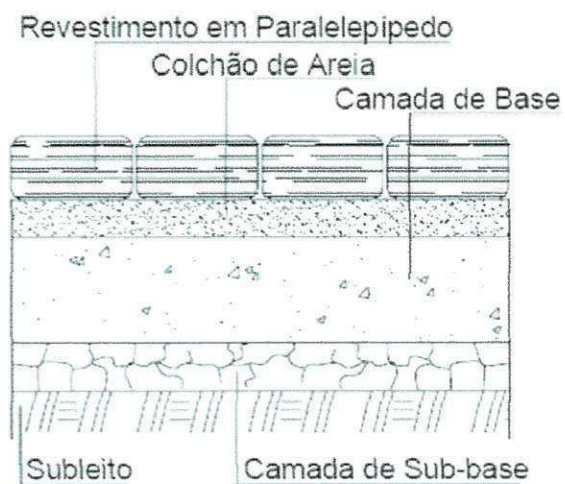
Estrutura do pavimento semi-rígido (Fonte: SILVA JÚNIOR, 2005).
